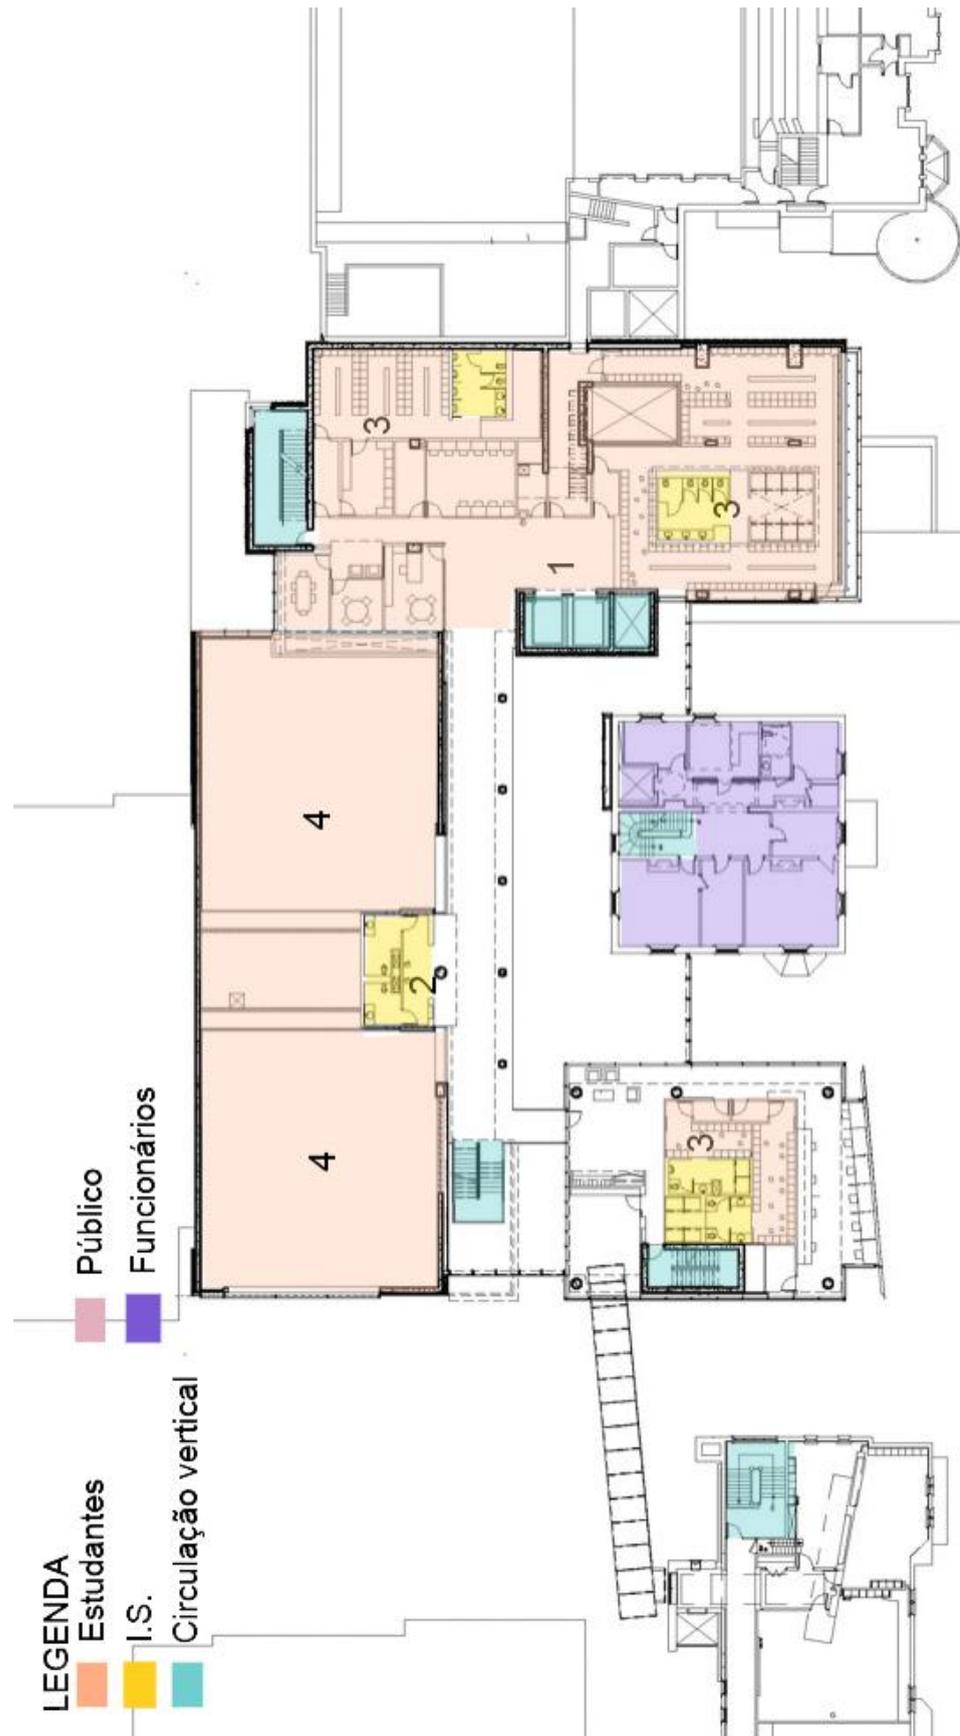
PLANTA SEGUNDO PAVIMENTO - SEM ESCALA
